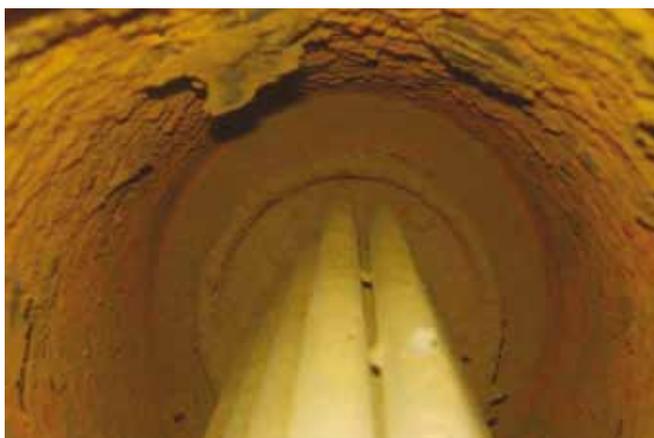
Corrosión de la cara interior de tubo de encofrado no galvanizado
